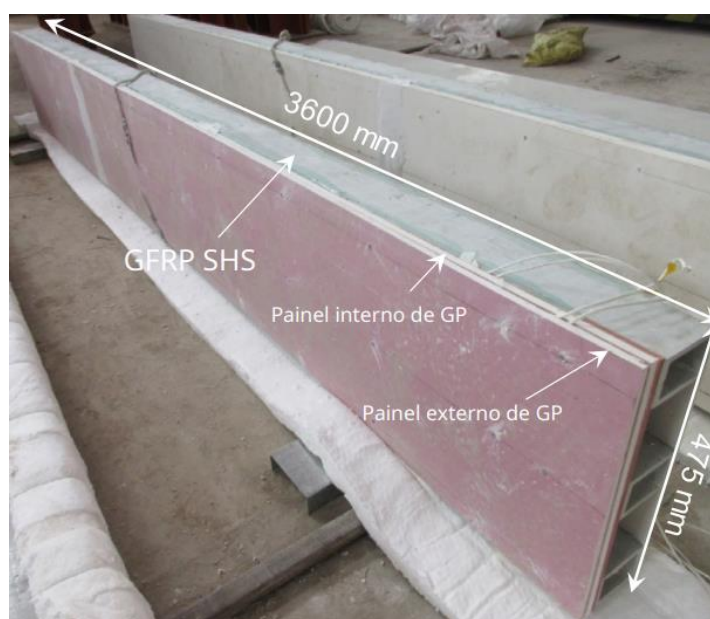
Configuração dos painéis (adaptado de Zhang *et al.*, 2021).
